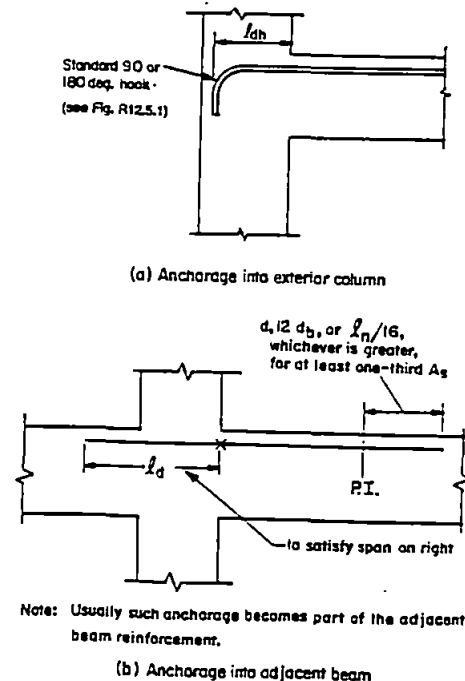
Longitud de desarrollo de la armadura por momento negativo.
